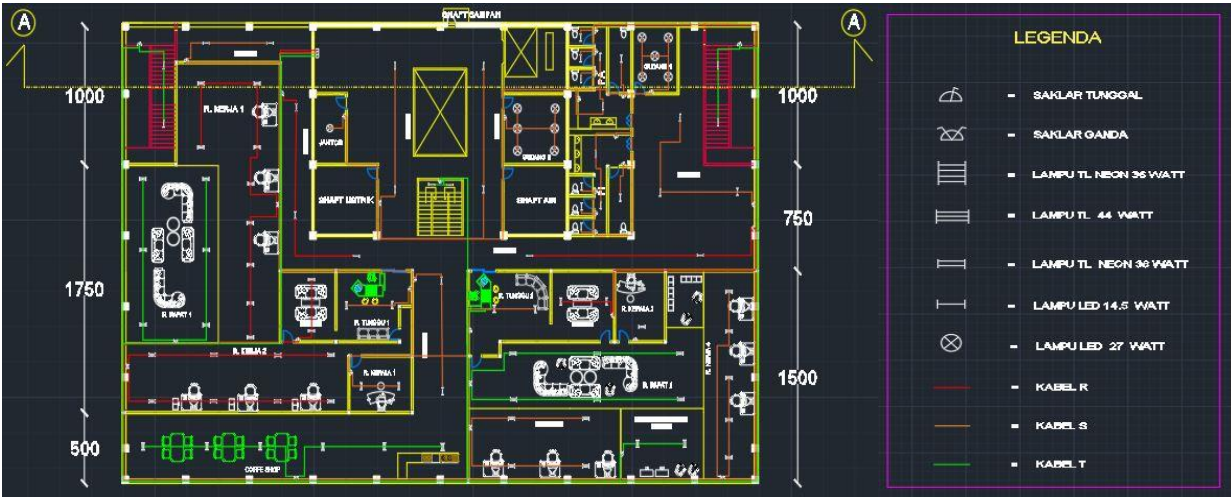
Panel AC lantai 3 Gedung Kantor Sewa
